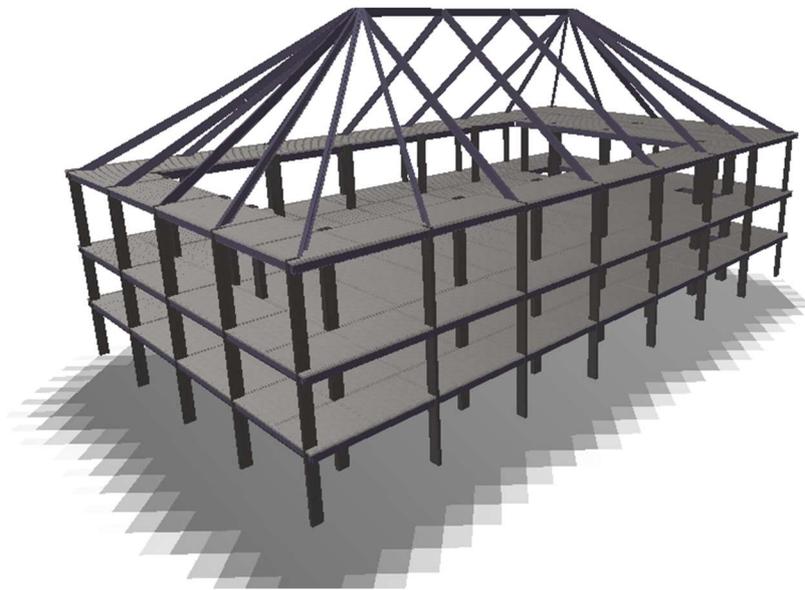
Imagem da superestrutura modelada CAD/TQS V22
